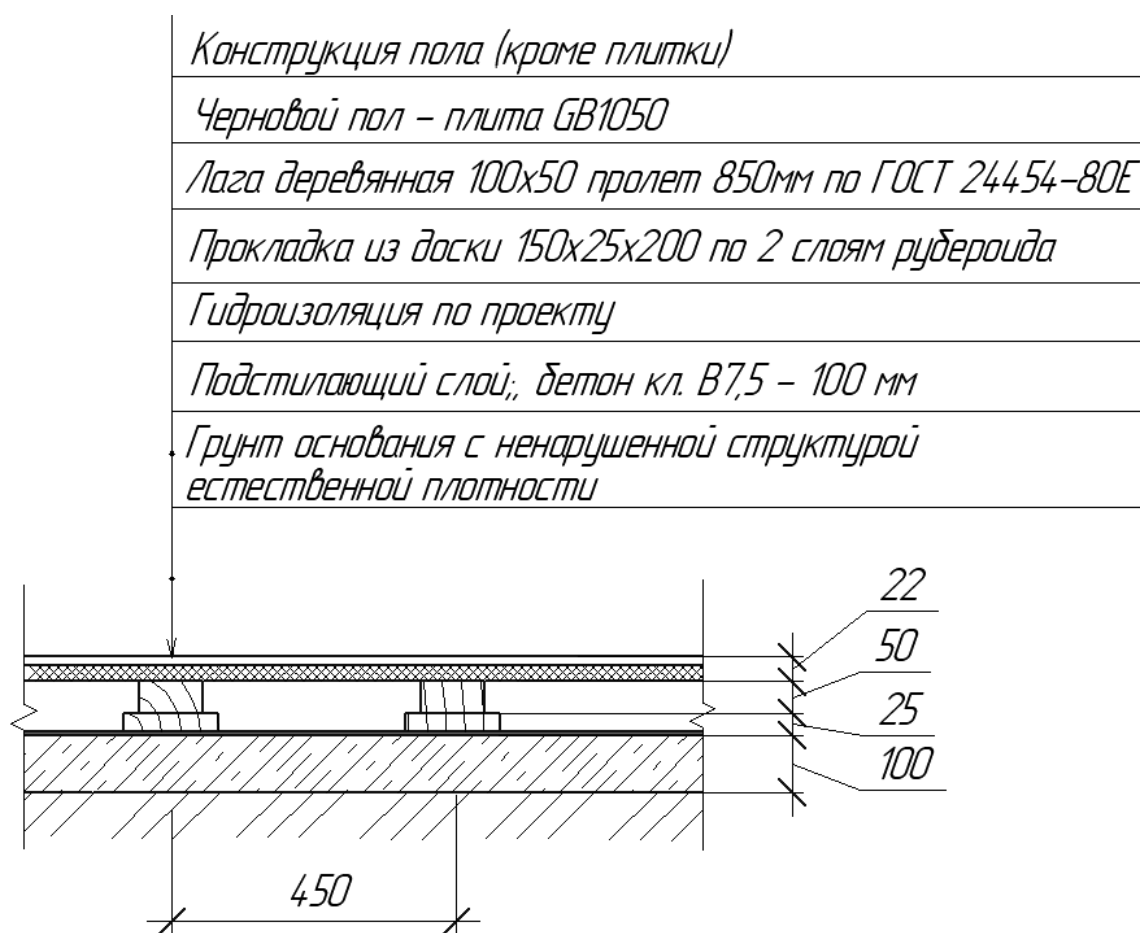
Конструкция пола по грунту с применением плит системы плит GREEN BOARD® без утепления с покрытием на деревянных лагах по подстилающему бетонному слою
